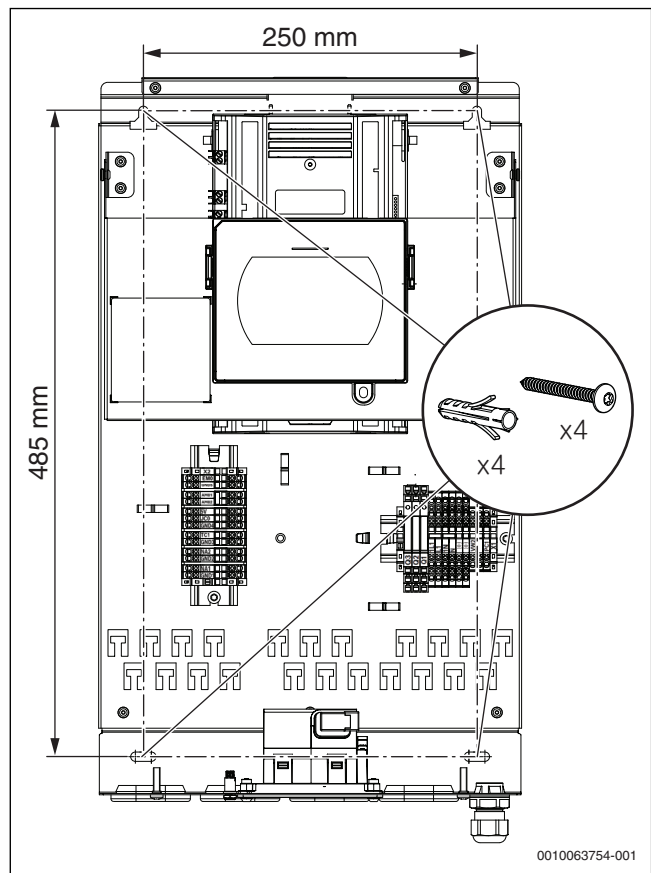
Befestigung des Wärmepumpenreglers an der Wand
